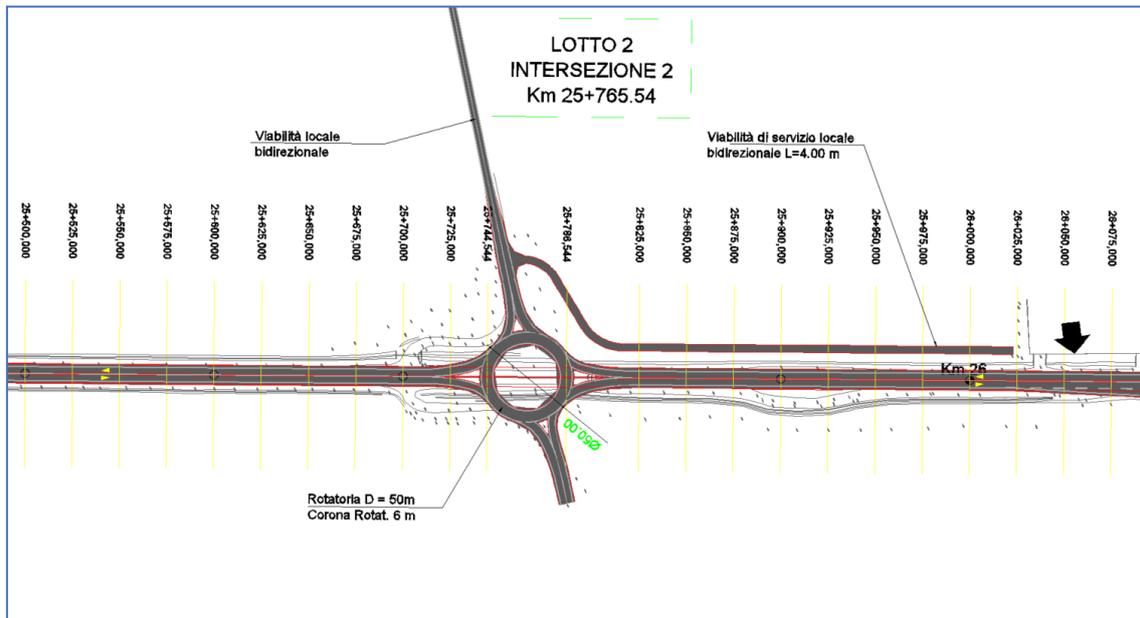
Intersezione 2 - Km 25+765 – Progetto
